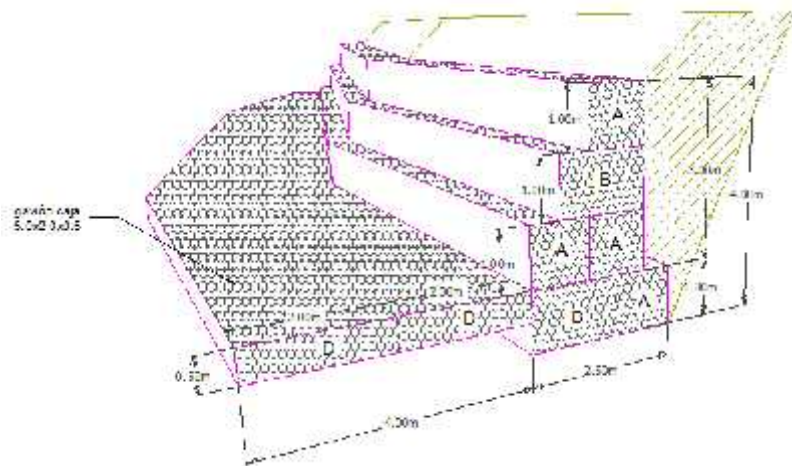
Estructura mediante gaviones caja y colchones reno.
